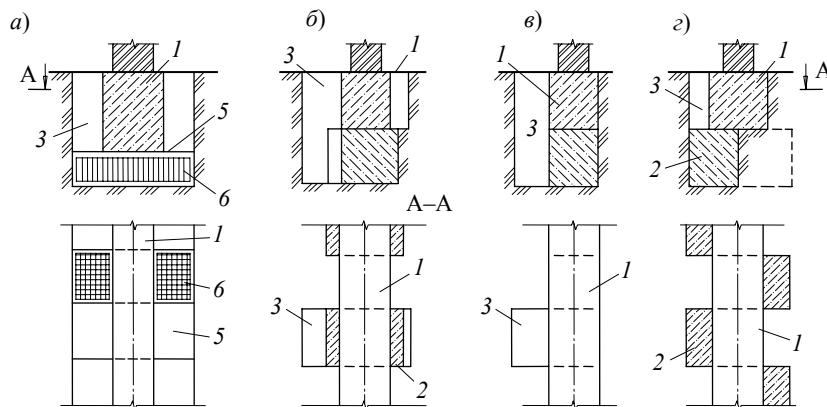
Варианты усиления подведением конструкций под фундаменты в виде:
